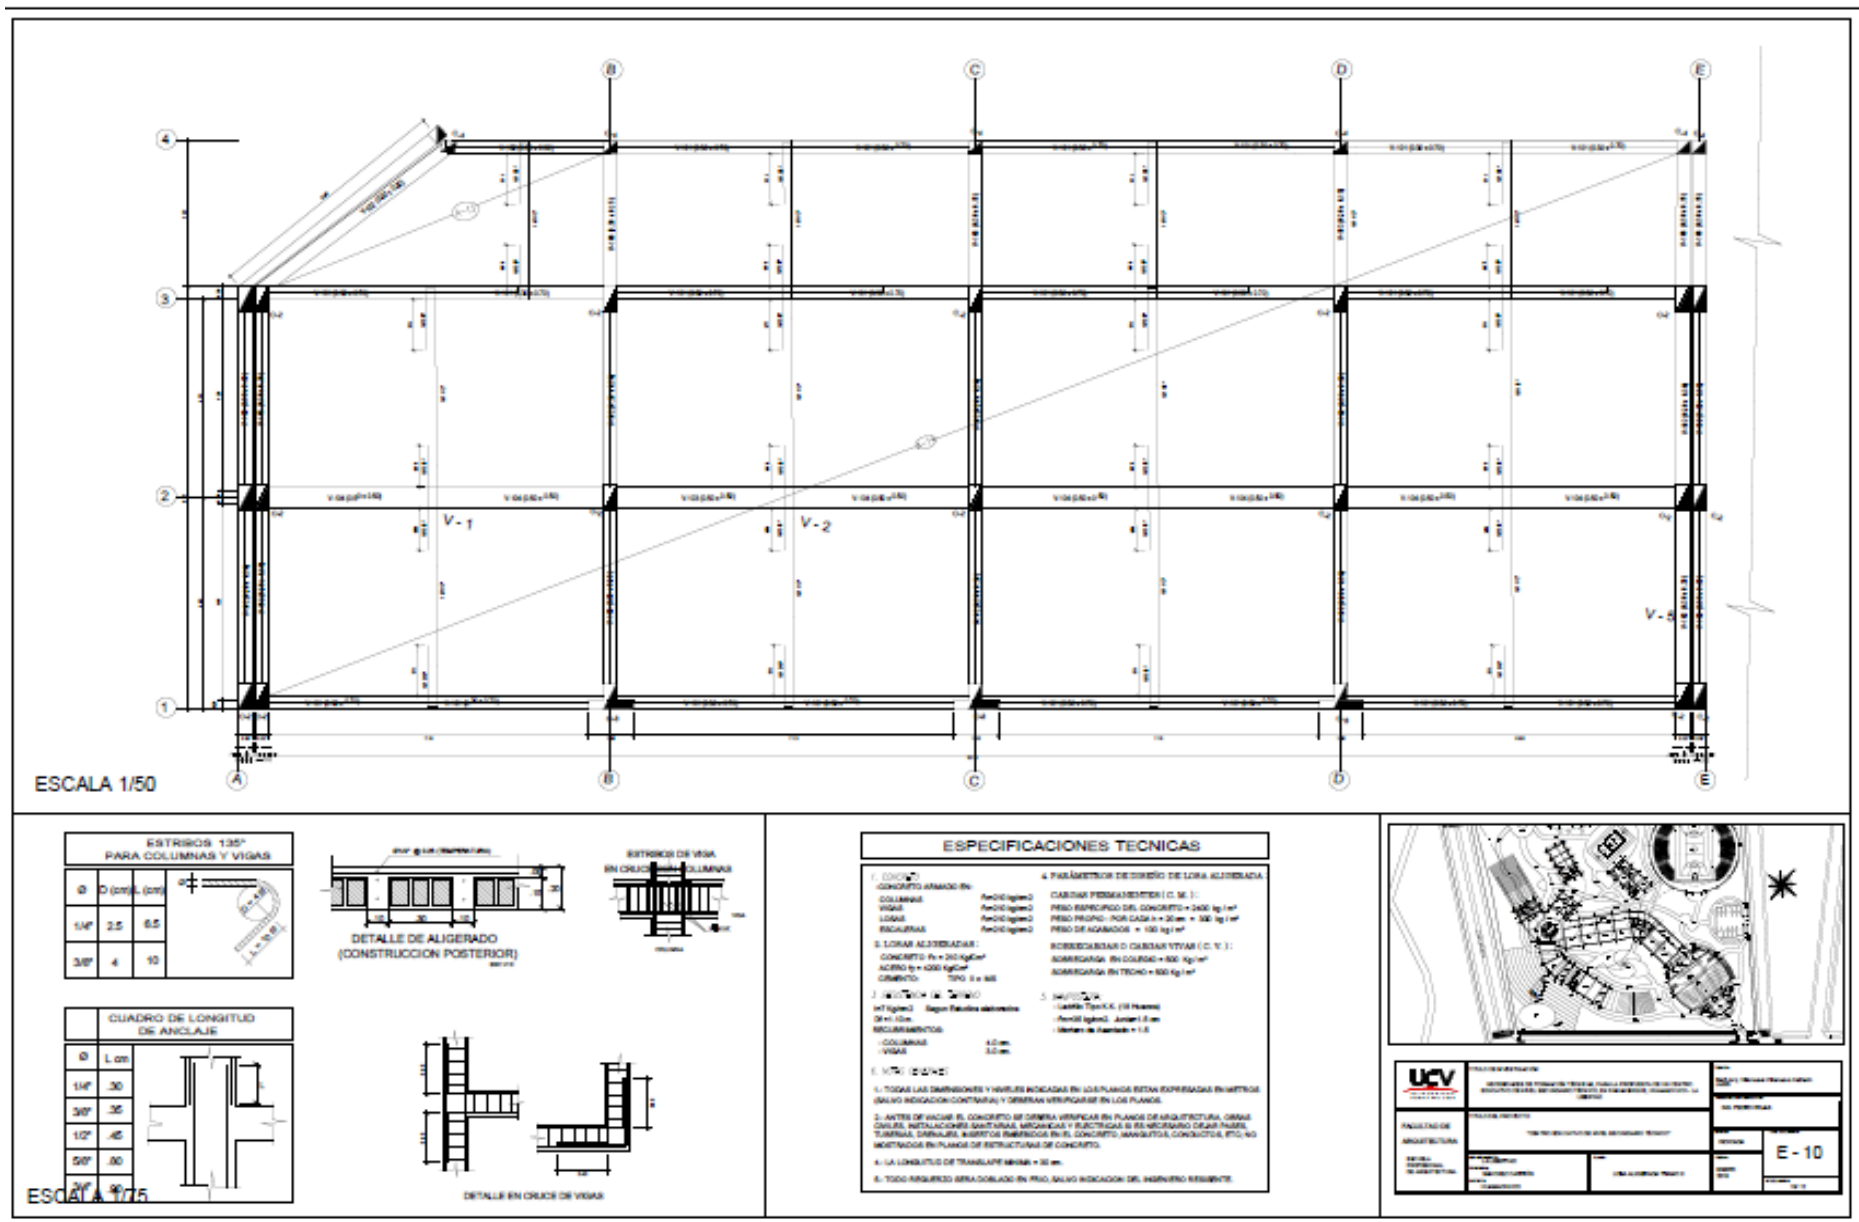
Plano Diseño Estructural Bloque 03 – Losa Aligerada - Plano N° 18 - Lamina E-10
